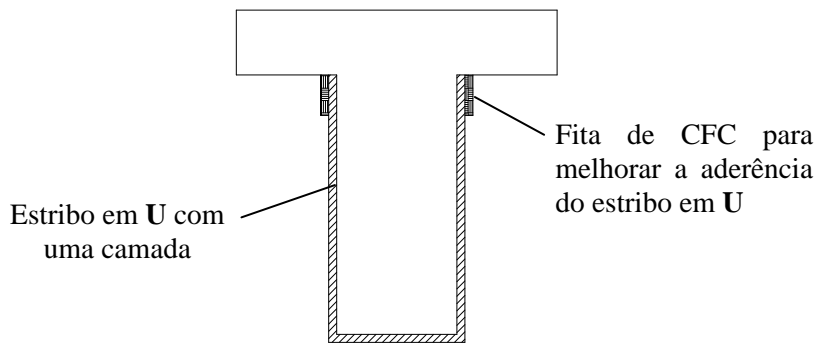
Seção transversal AA' das vigas reforçadas VI-1 e VII-1.
